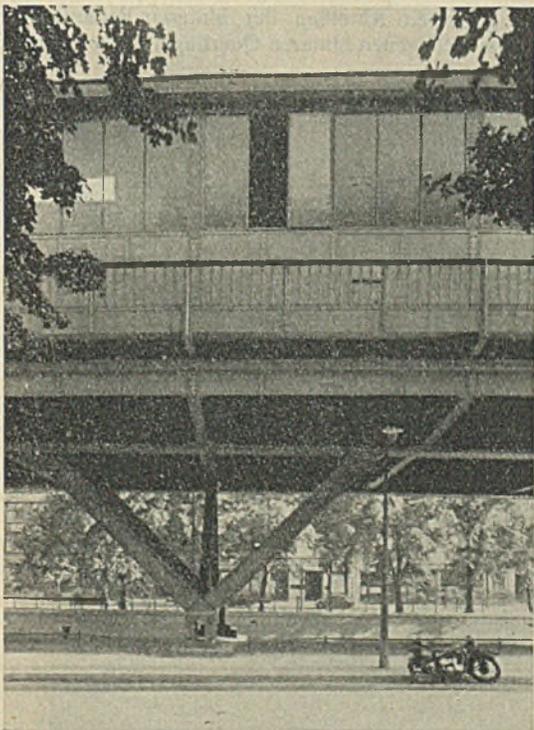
Ansicht der Halle mit den Spreizen (bewegliches Lager).
